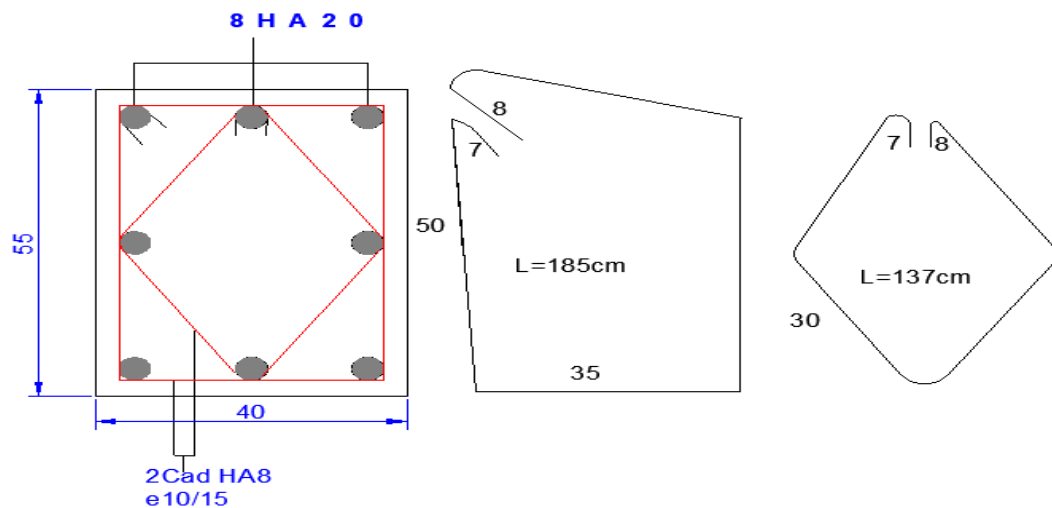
Schéma de ferrailage poteaux (40x55)
